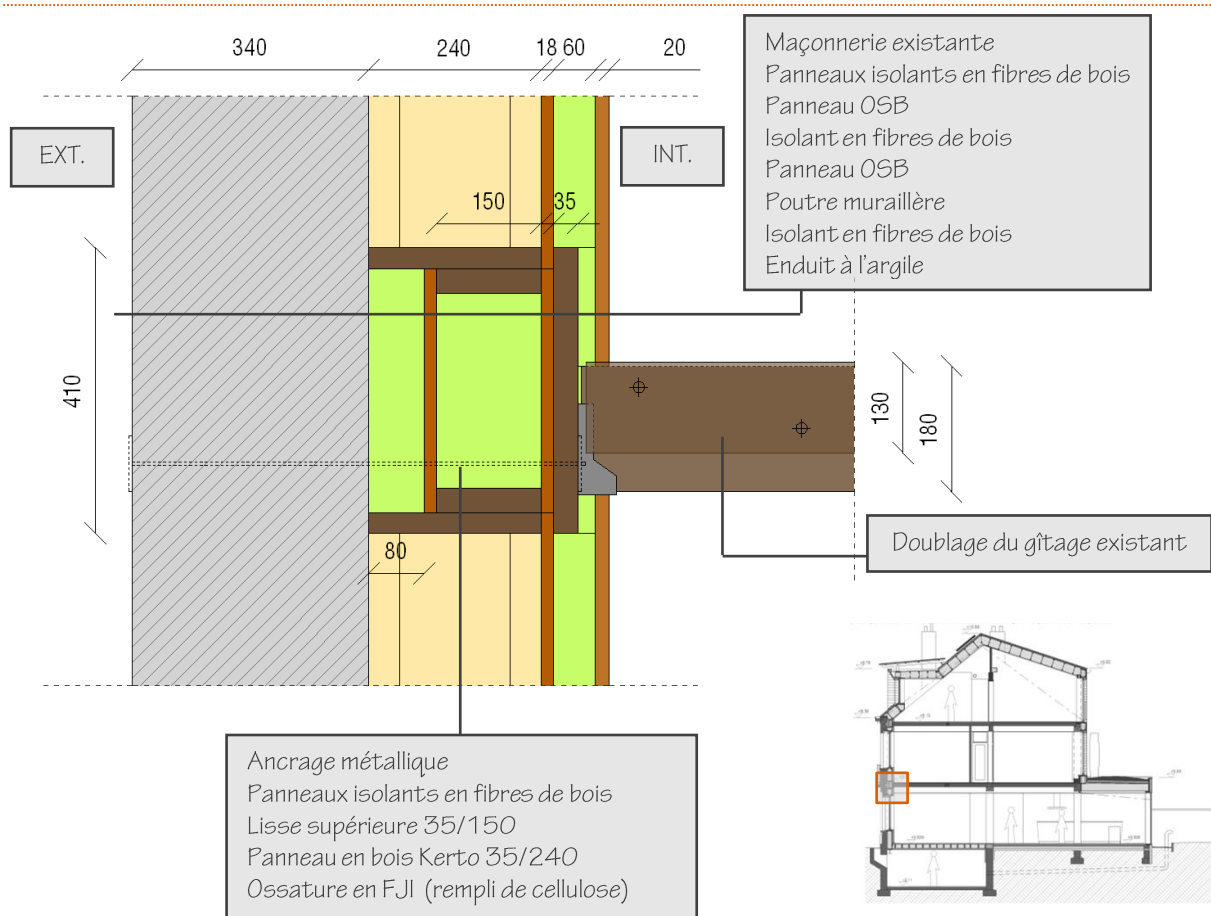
Détail en coupe de la façade avant, mesures en [mm]
